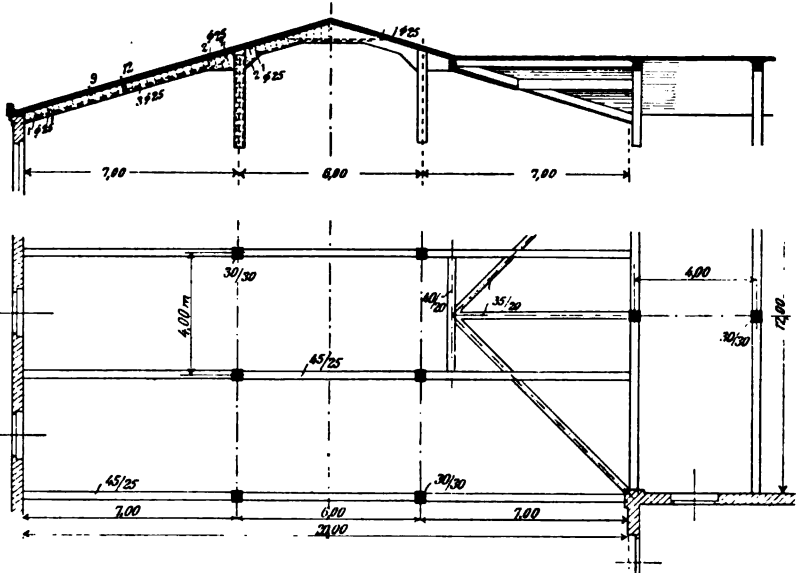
Verschneidung eines Ribpenbalkendaches über drei Feldern. Schnitt und Grundriß.
